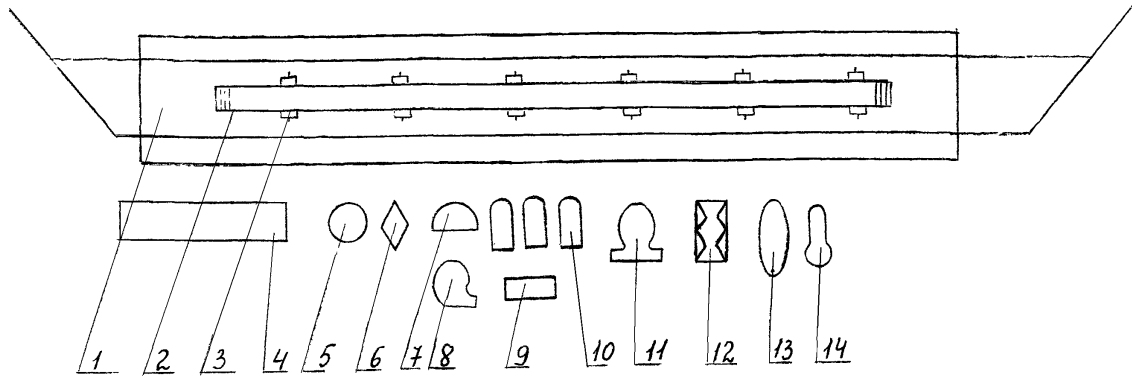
Рис. I. СХЕМА ПЛОЩАДКИ ОБРАБОТКИ ЦИСТЕРН ИЗ-ПОД ЭТИЛИРОВАННОГО БЕНЗИНА НА ППС.
